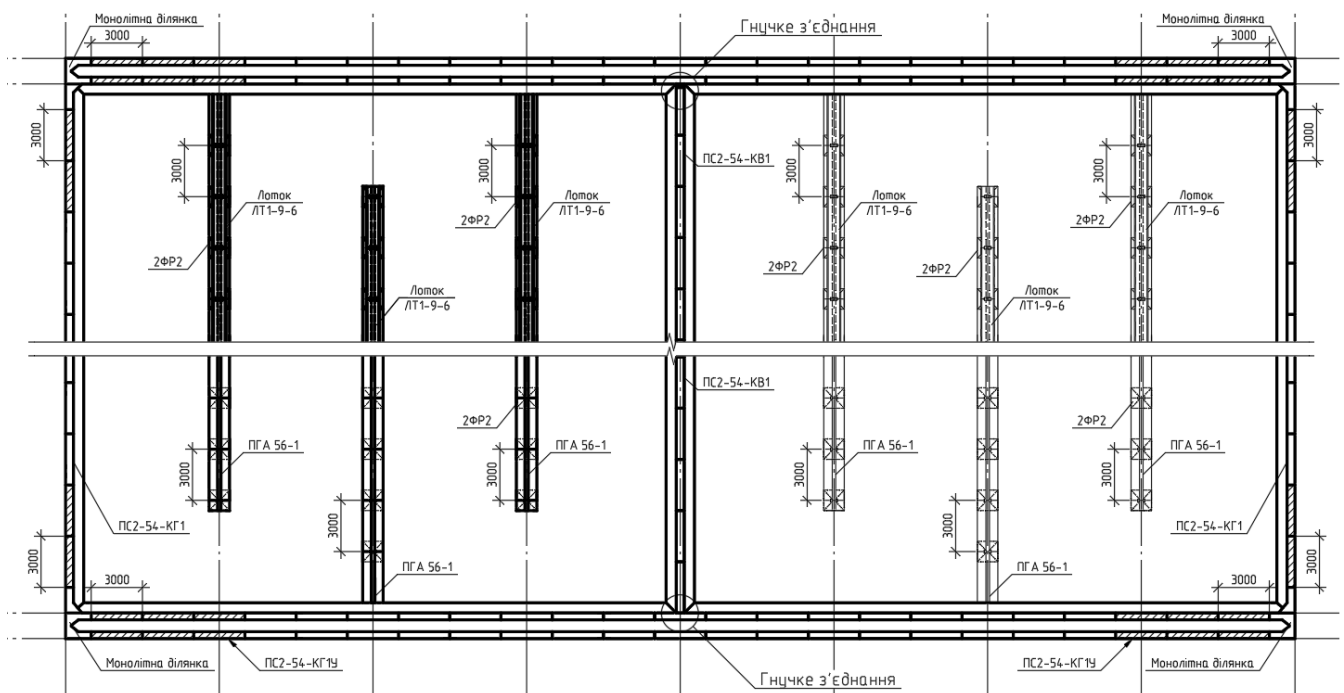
Схематичний план аеротенка з маркуванням конструкцій каркаса
